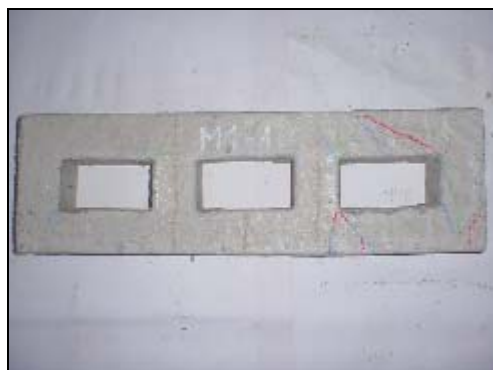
8 Grietas estructura 2 modelo 1
